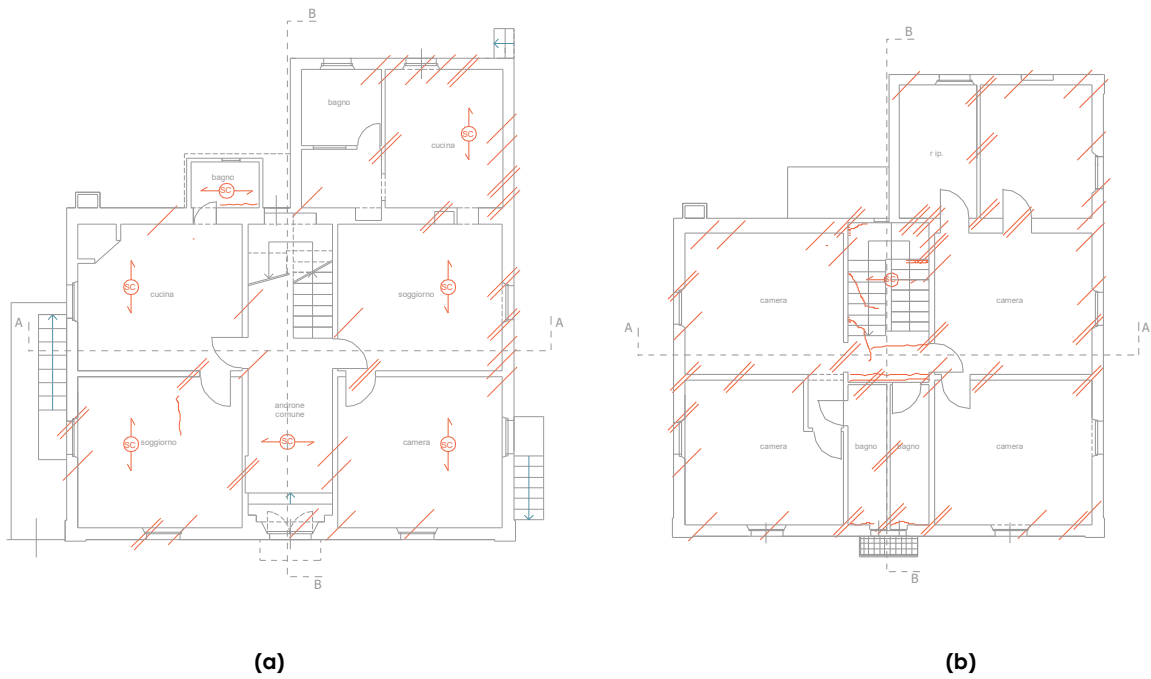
Rilievo del quadro fessurativo: pianta piano terra (a) e pianta piano primo (b)
